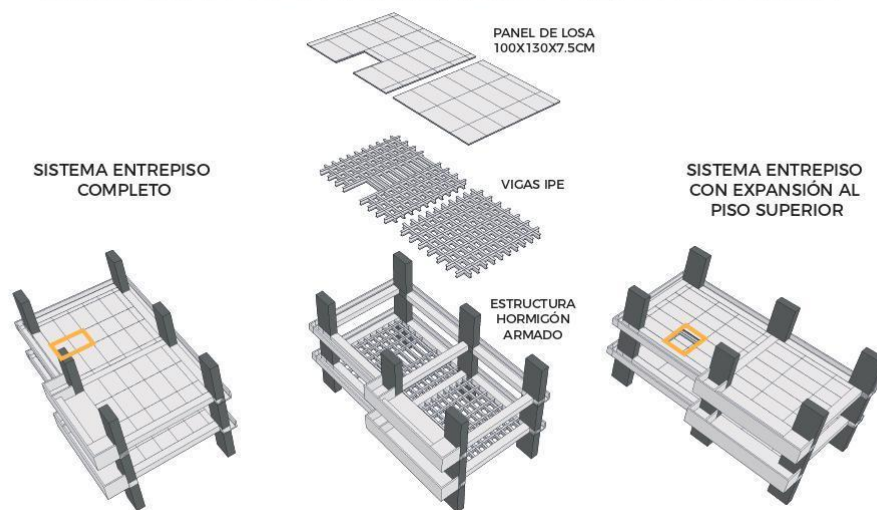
Sistema prefabricado de losa - Modificación propuesta
